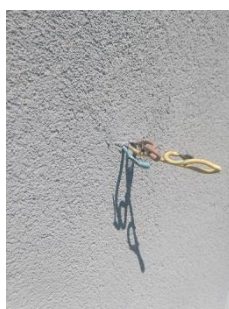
Ponto de ligação de luz [Foto tirada em obra]
